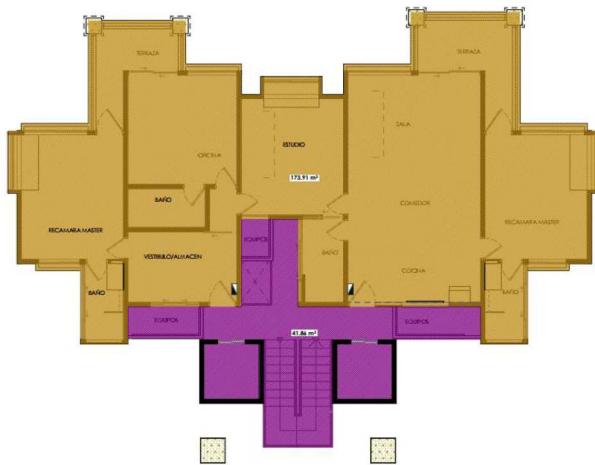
Planta arquitectónica tipología repetitiva del segundo nivel hasta el doceavo nivel
